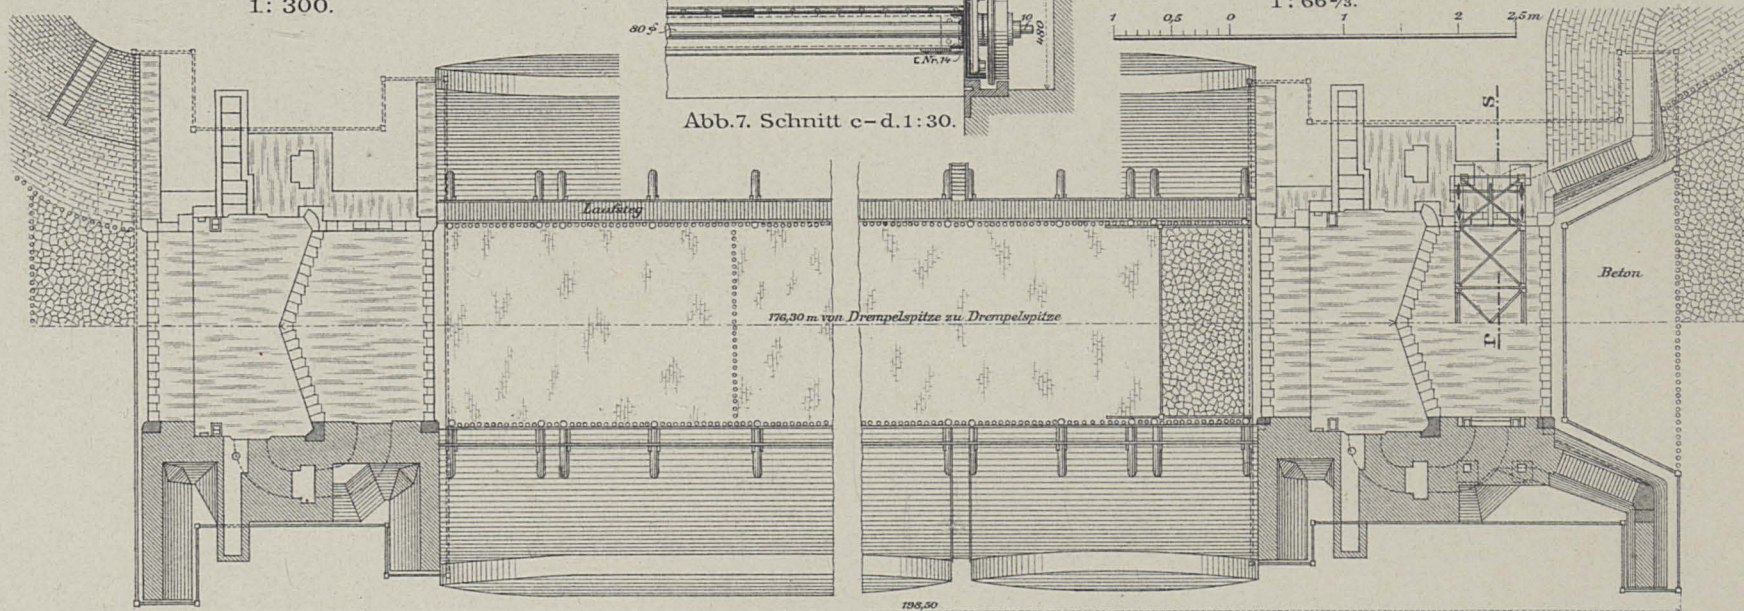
Grundriss u. Oberansicht. 1: 400.
